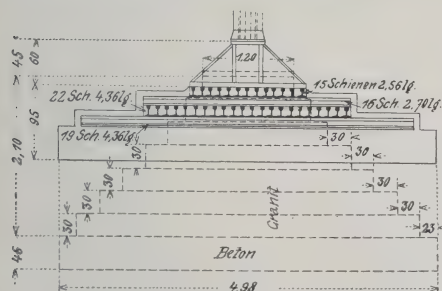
Säulenfuß in Beton, Betoneisen oder Eisenbeton.
